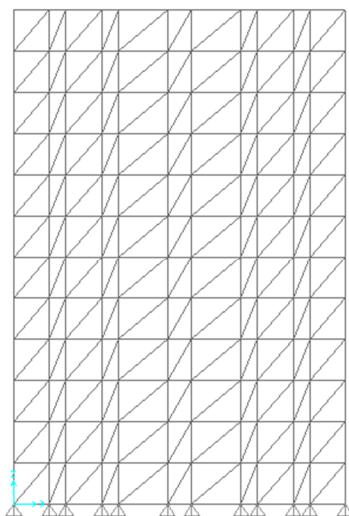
Configuração dos Planos de Contraventamento Vertical Com Elementos de Contraventamento Pequenos
